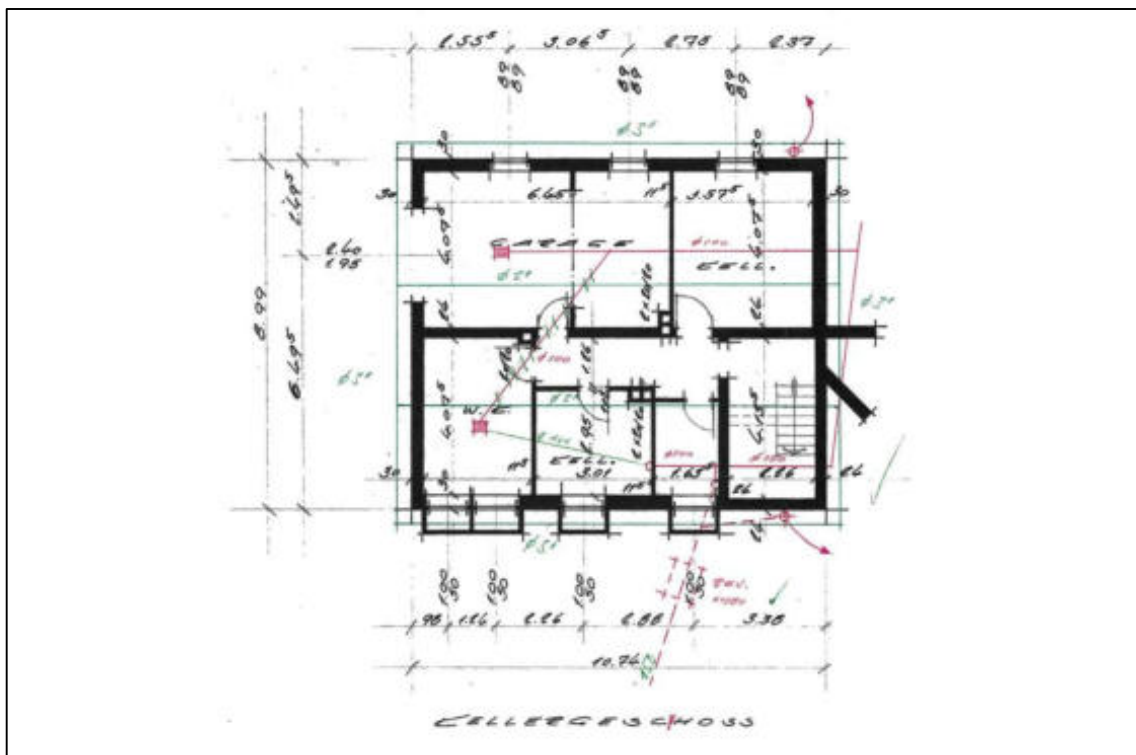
Grundriss vom Kellergeschoss
